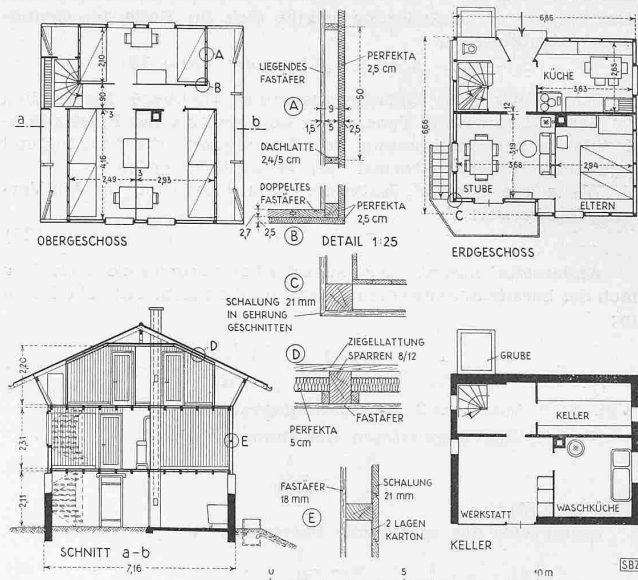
Grundrisse und Schnitt 1:250; Einzelheiten 1:25
